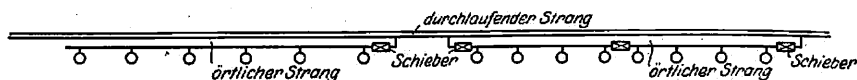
Trennung der örtlichen Saugstränge von dem durchlaufenden Hauptstrang.
